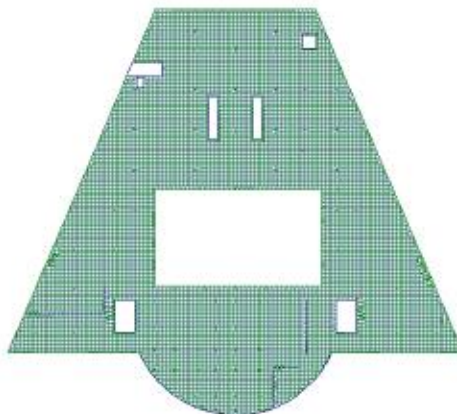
Площадь полной арматуры на 1 мм по оси Y у нижней грани
